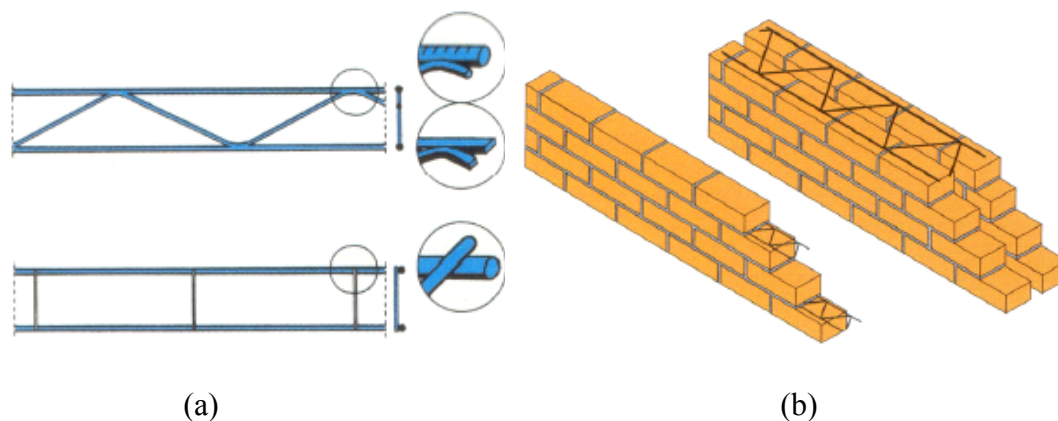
Exemplos: (a) de dois tipos de armaduras de junta para alvenaria; (b) de aplicação da armadura de junta em paredes simples e paredes duplas (PEREIRA, 2005).
